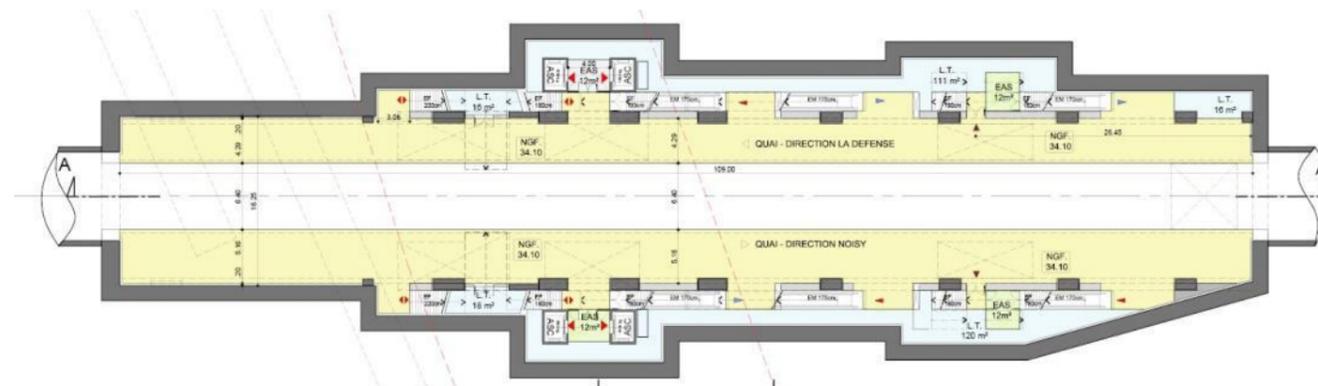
Gare d'Arcueil Cachan – Plan niveau N-4
